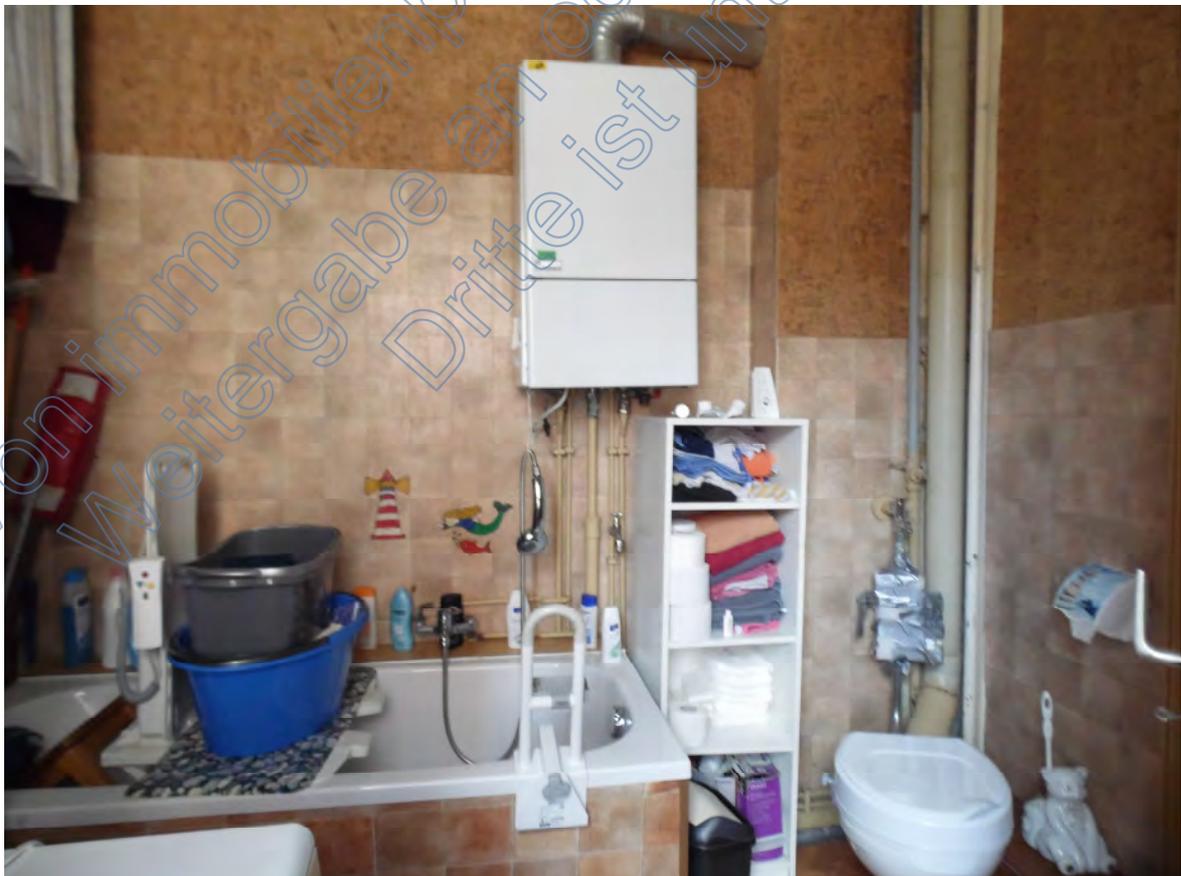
Ausschnitt – Bad Richtung Badewanne, Therme und WC-Becken
